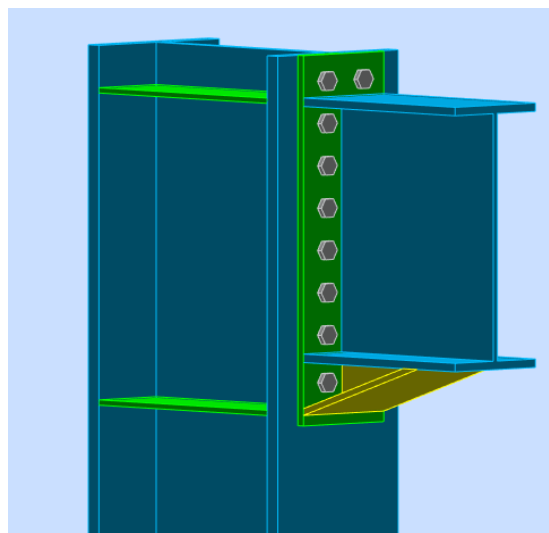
Vue d'assemblage poteau – poutre.
